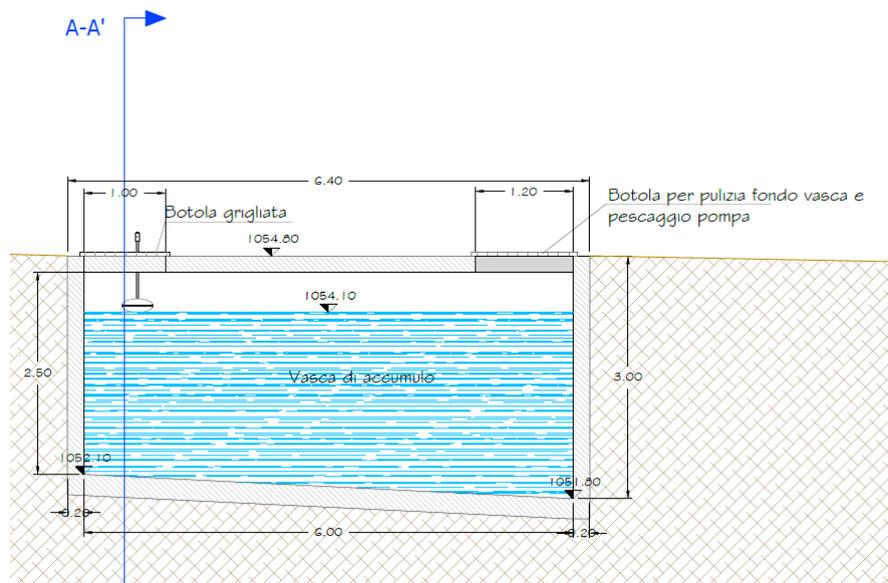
Estratto Tavola 7 del progetto irriguo – sezione longitudinale vasca in località Pian delle Rovine
